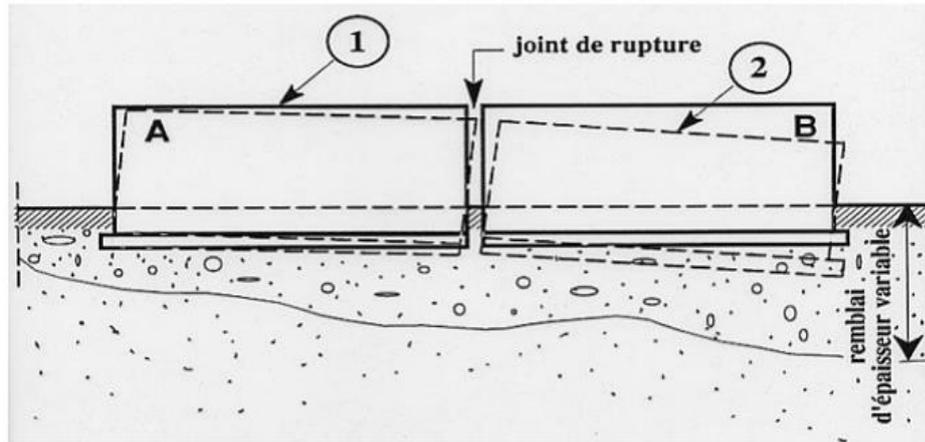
Tassement différentiel des fondations-Remblai d'épaisseur variable.
